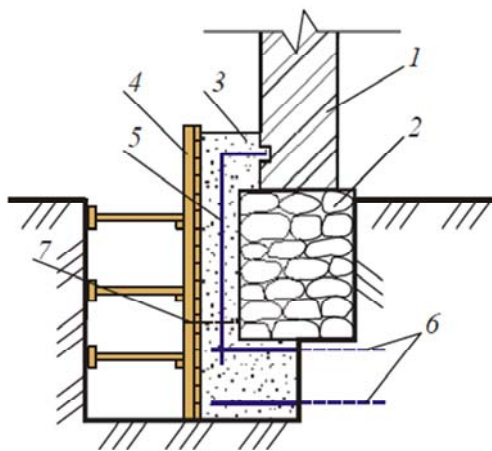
Углубление подошвы фундамента с одновременным расширением (без разгрузки):
